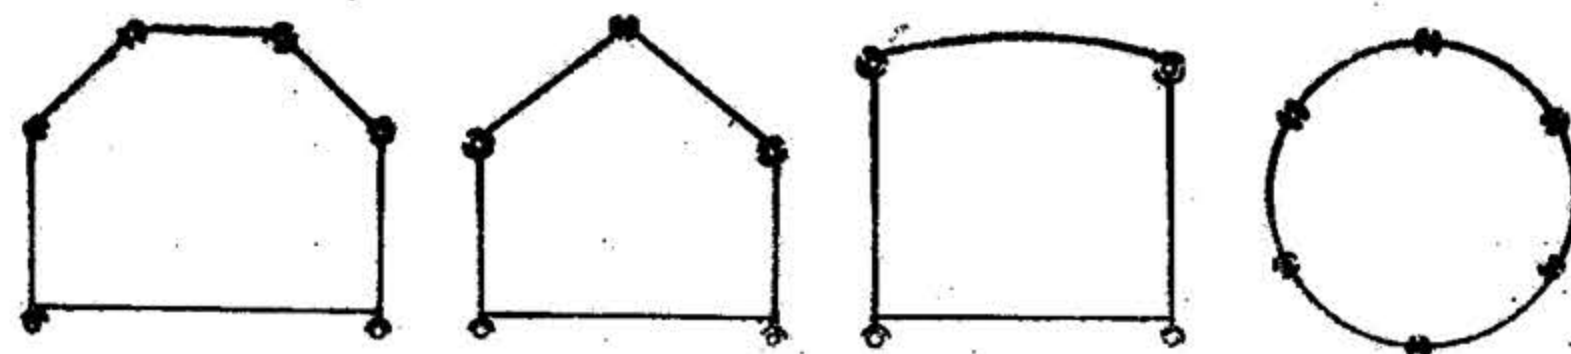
Scheme de susținere cu cadre prefabricate din beton armat.
